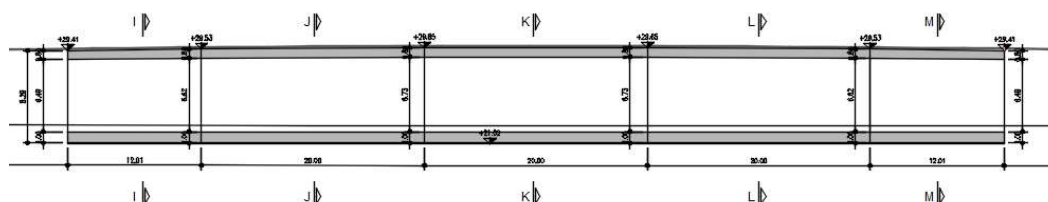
Sezione longitudinale scatolare zona rotatoria
